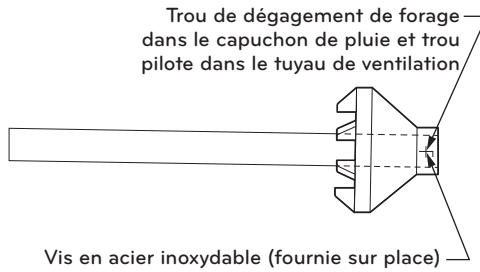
Ensemble alternatif du capuchon de pluie au tuyau de ventilation
